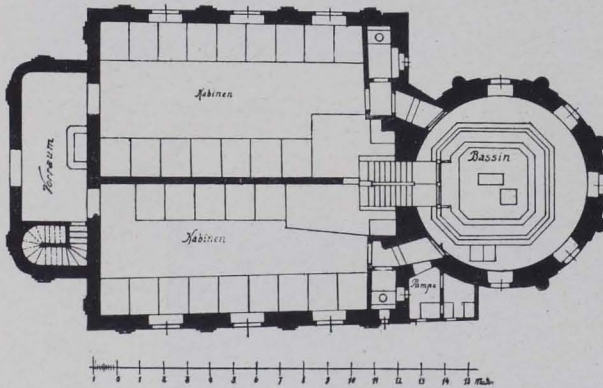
Baden, Josefsbad, Grundriß, 1 : 300 (S. 64).
